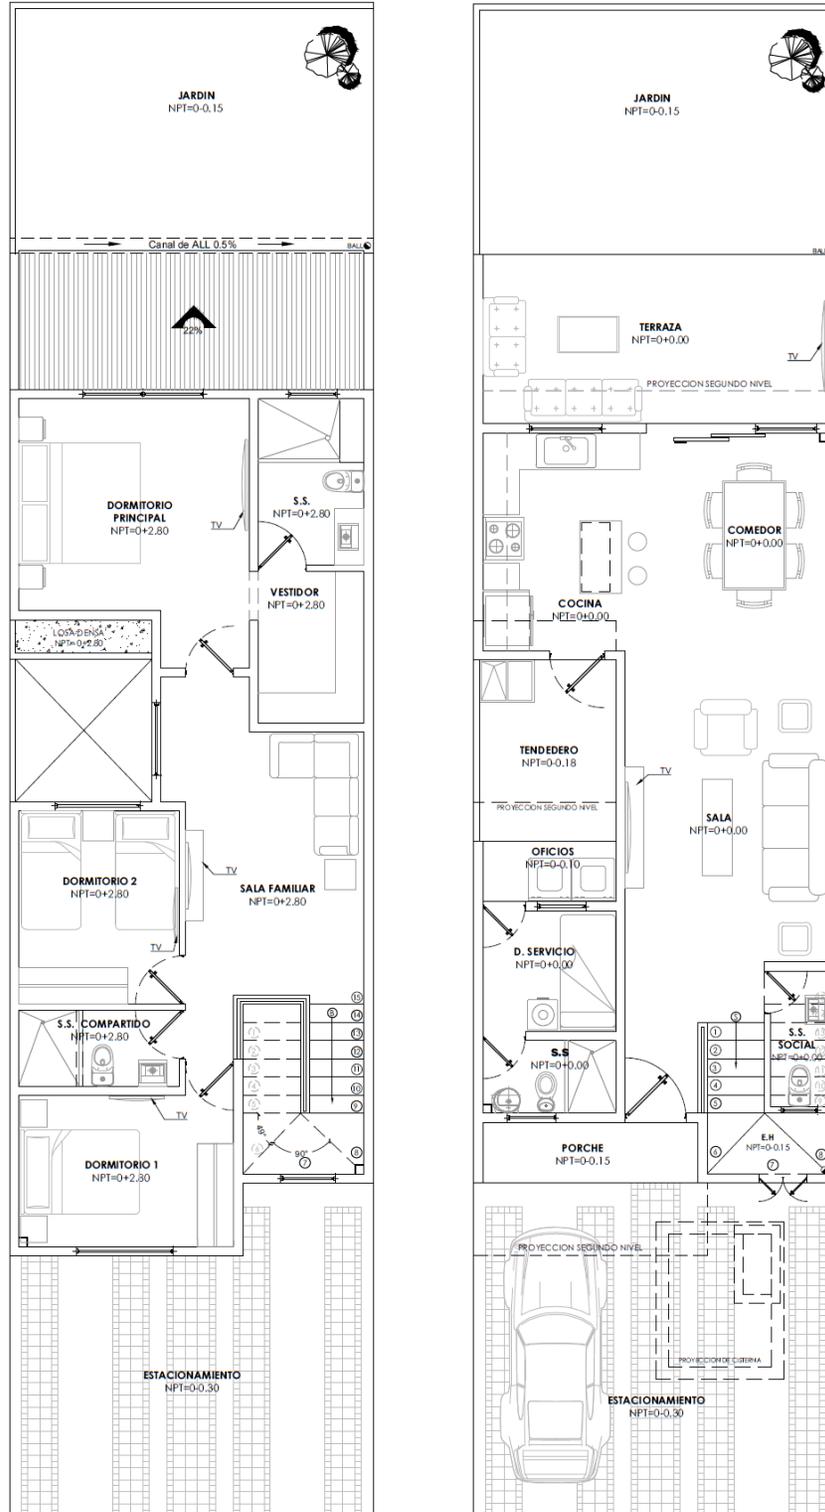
Plantas arquitectónicas casa tipo Venecia
